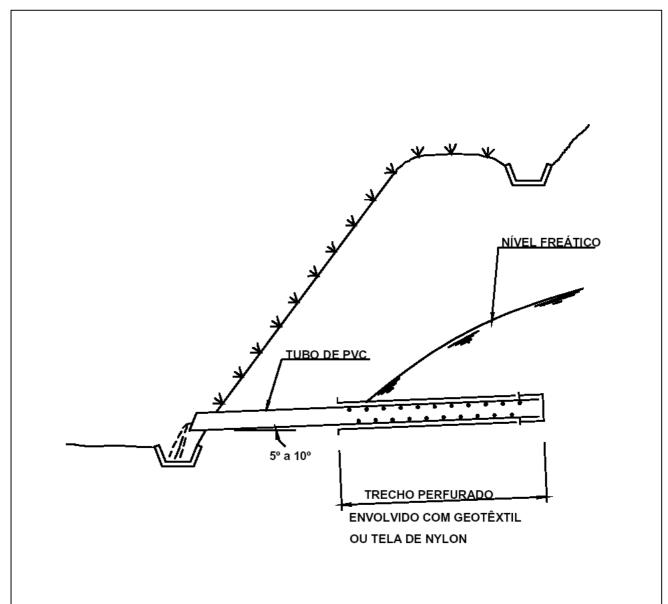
Detalhe de um dreno horizontal profundo (DHP)
